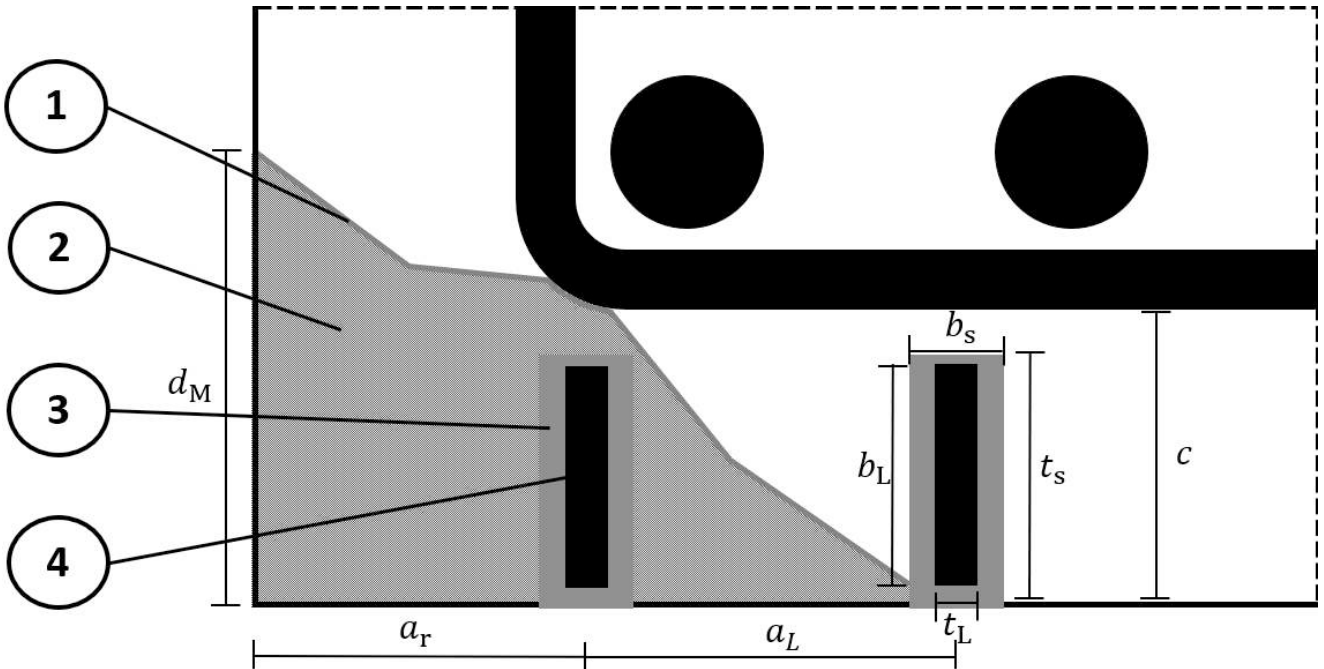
Querschnitt eines Stahlbetonbauteils verstärkt mit FRS-L-S NSM in Schlitze verklebten CFK-Lamellen mit dem FRS-CS Epoxidharzklebstoff und (optionaler) vorangegangener Betonreparatur mit dem Betonersatzsystem FRS-PC 11 und der Haftbrücke FRS-BA.
